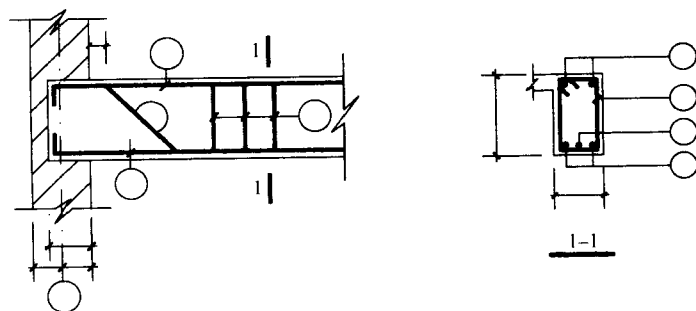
梁纵、横断面图中钢筋表示方法
